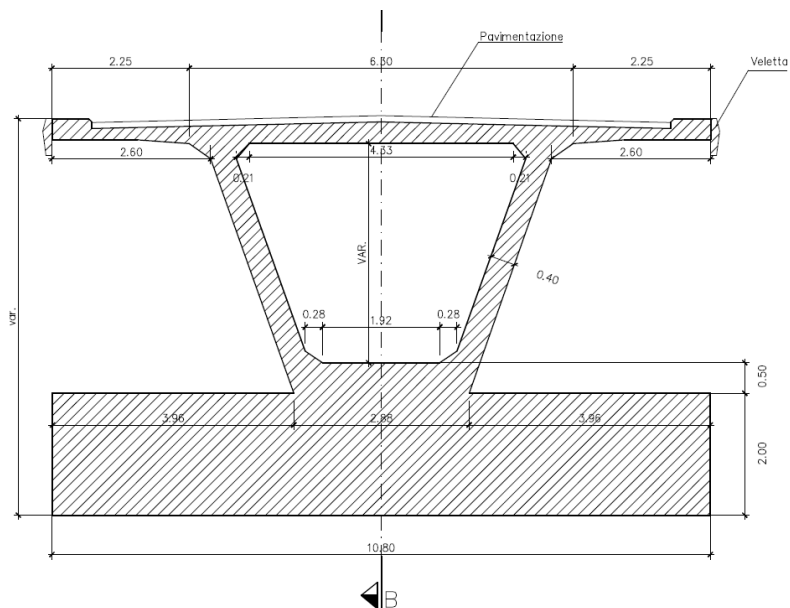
Sezione trasversale della spalla, sezione C-C (in corrispondenza della prima camera)
